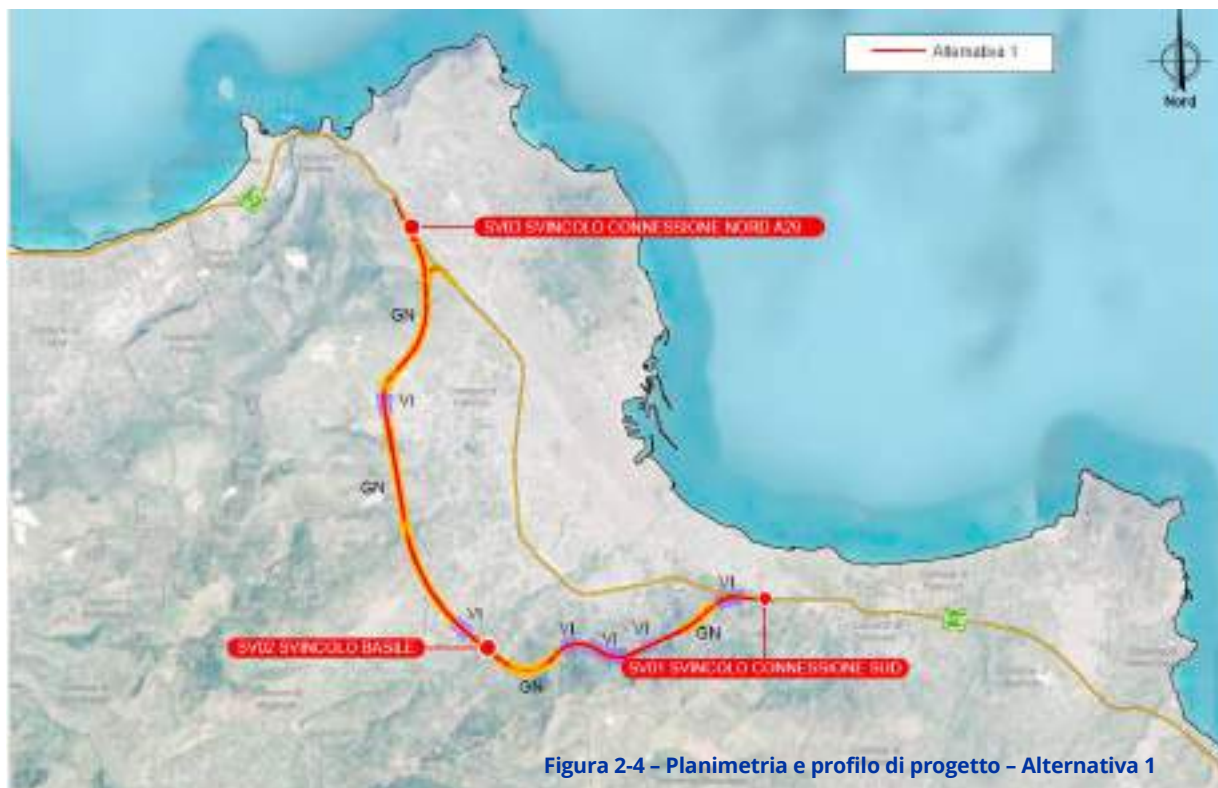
Planimetria e profilo di progetto - Alternativa 1
